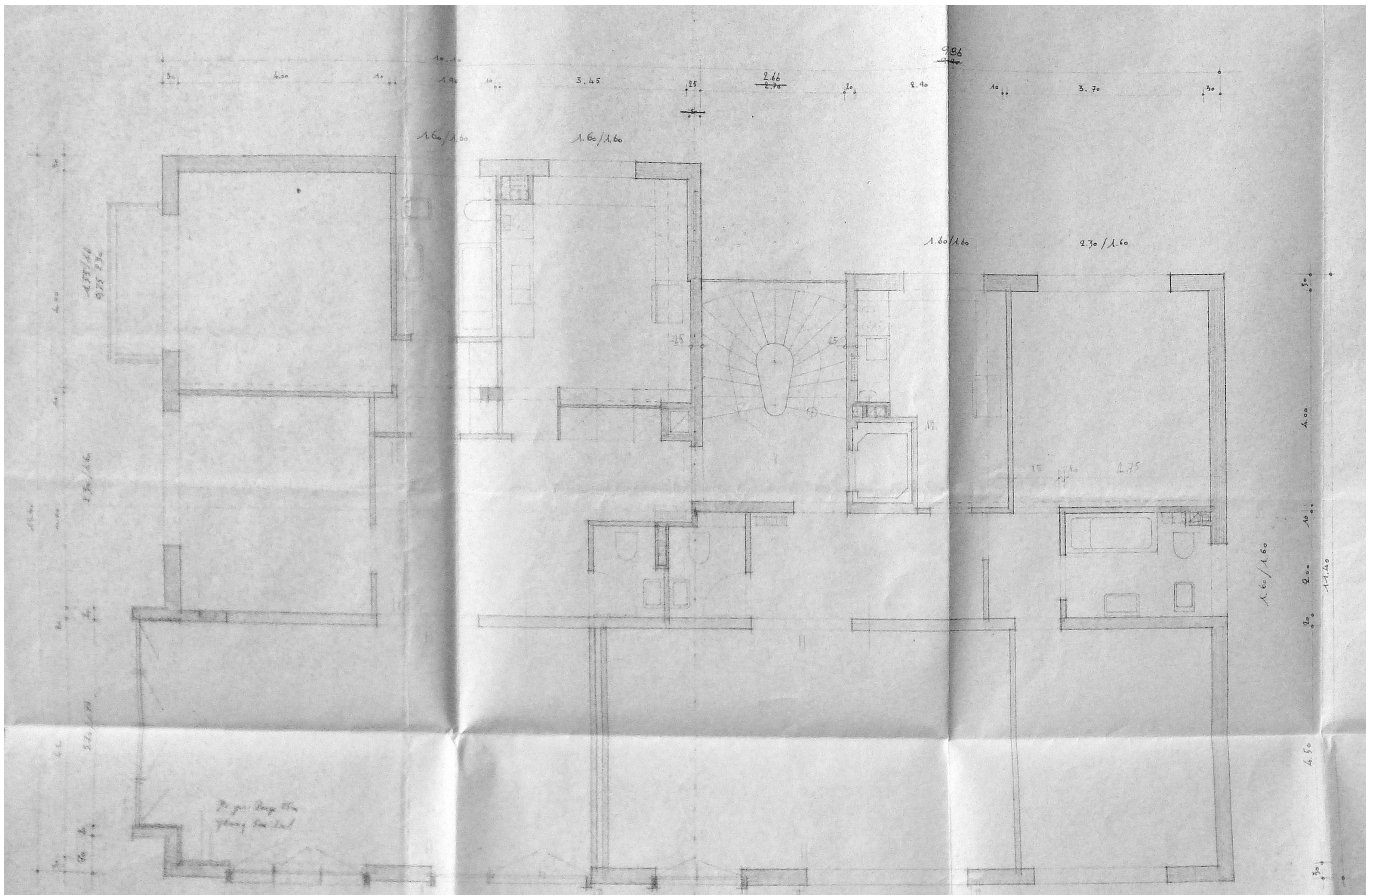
Grundriss, Regelgeschoss mit zwei Wohneinheiten (1954)
